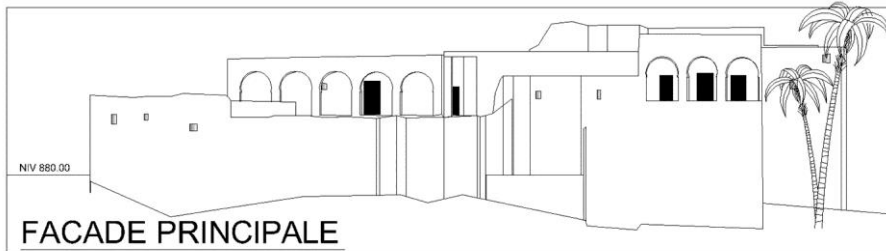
(Plan de façade de la Zawya Tidjania à Boussemgoune)
